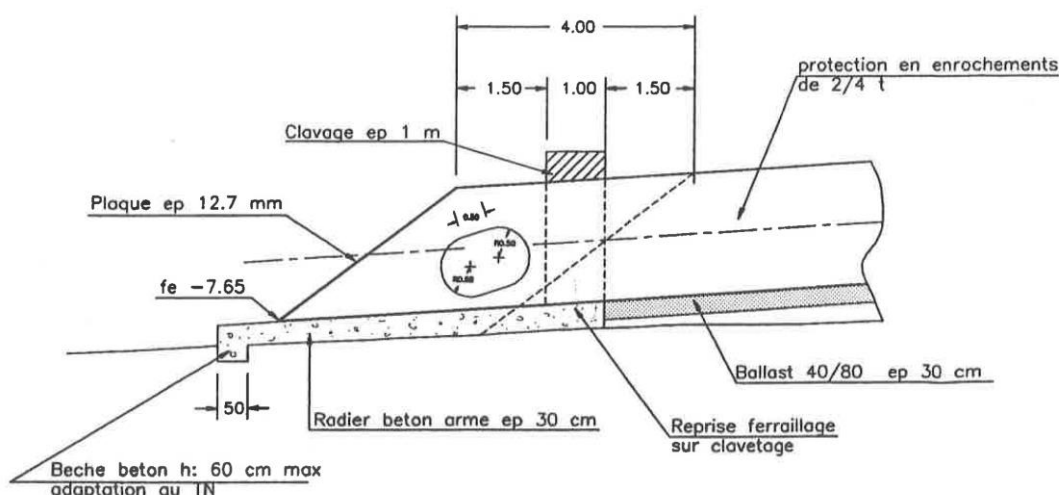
Coupe longitudinale du diffuseur (Source SPADA 1193)
